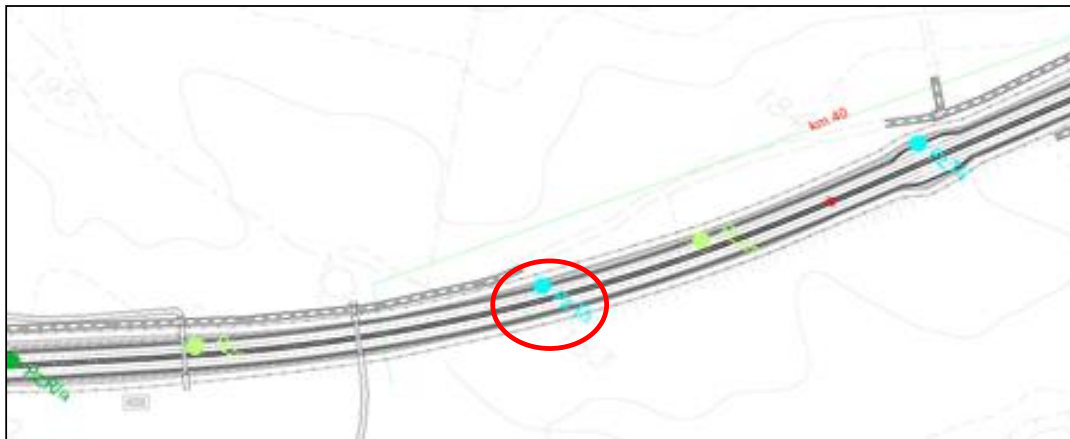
FOTO SATELLITARE CON PROIEZIONE DEL POZZETTO PZT3
